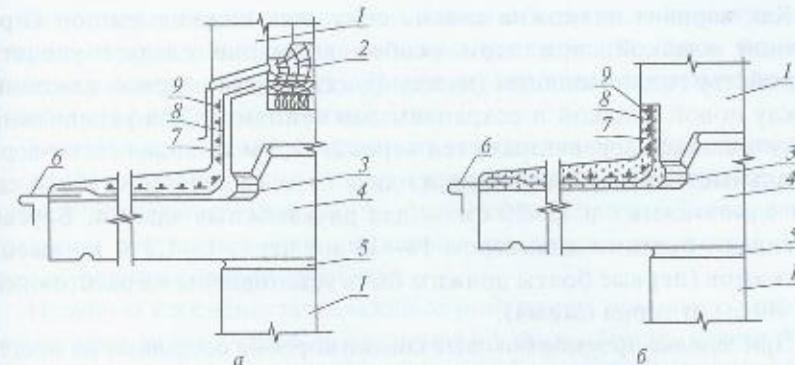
Герметизация мест примыкания балконной плиты к наружным стековым панелям:
